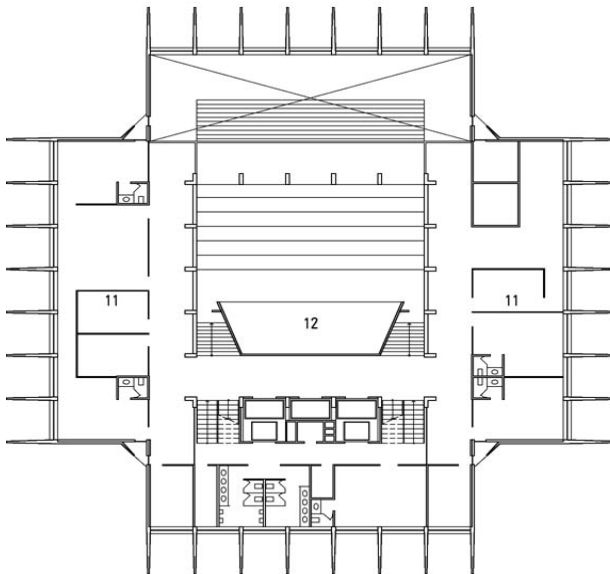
Palácio da Justiça. Projeto: Saraiva, Petracco e Bussab [1968] Planta baixa sala do júri. 6º pavimento. [Fonte: Arquivos do arquiteto, 2008].
